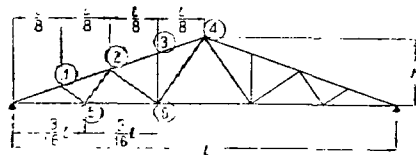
Схема треугольной фермы с переменным направлением раскосов
